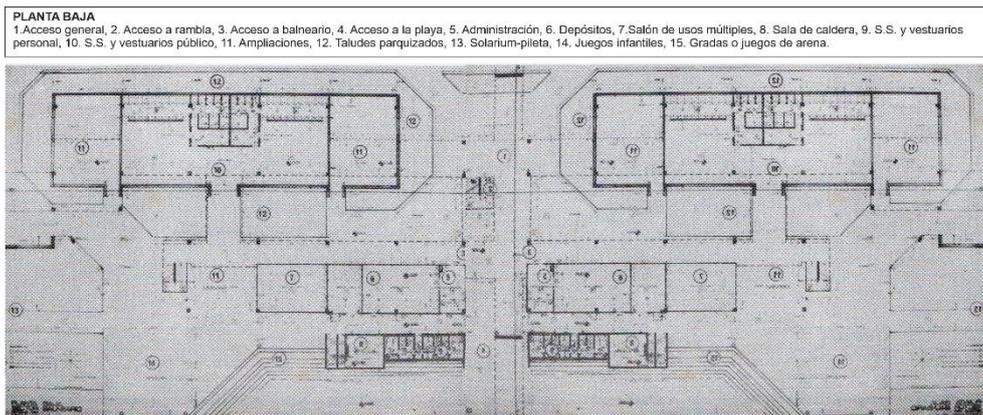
Planta baja de unidad balnearia, primer proyecto. Elaboración propia sobre plano en Proyecto Punta Mogotes (1980).
